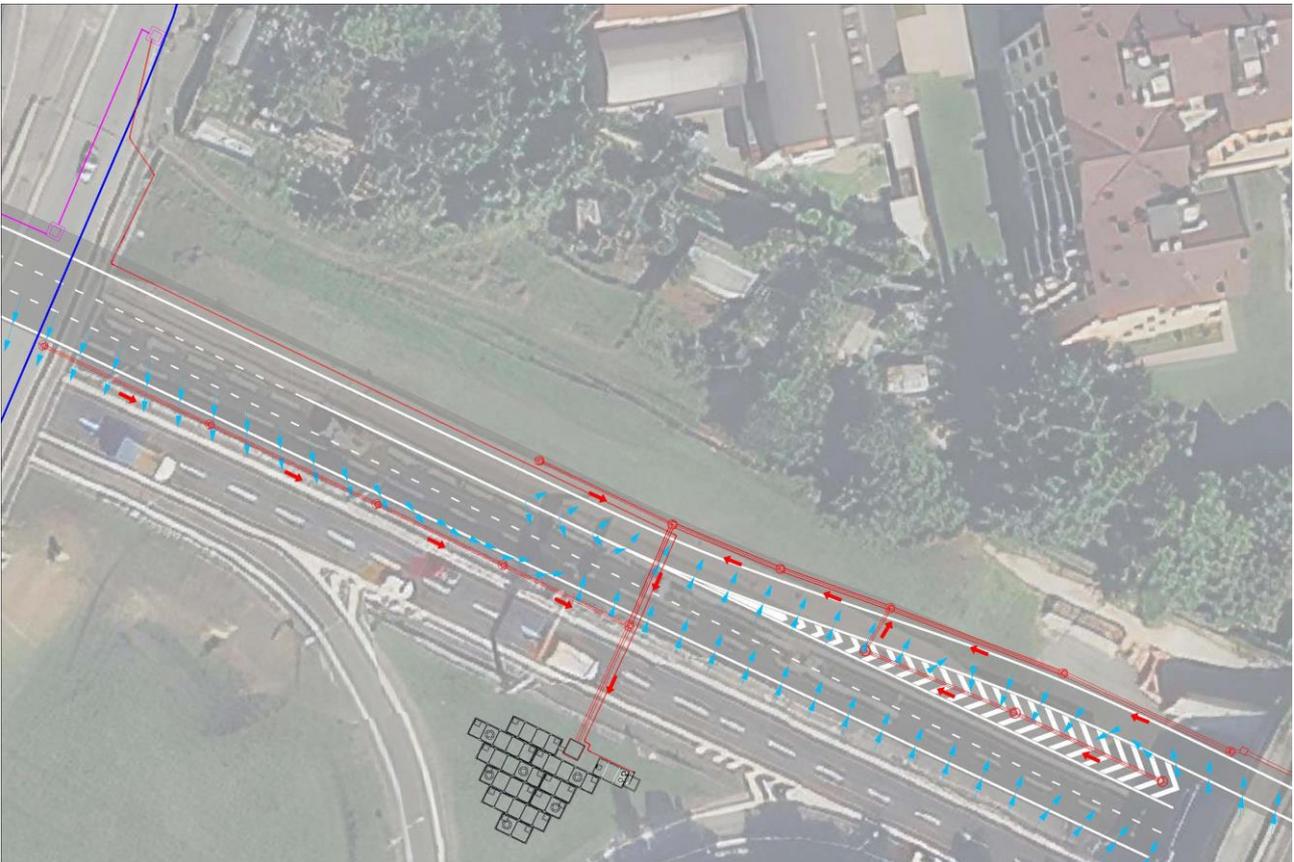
Stralcio planimetrico del sistema di drenaggio e di gestione delle acque dell'Asse principale (TR06 + TR07 + TR08) con evidenza della vasca di laminazione e infiltrazione VV1 e (nell'immagine successiva) dettaglio della vasca di prima pioggia PP1 e di stoccaggio sversamenti accidentali
